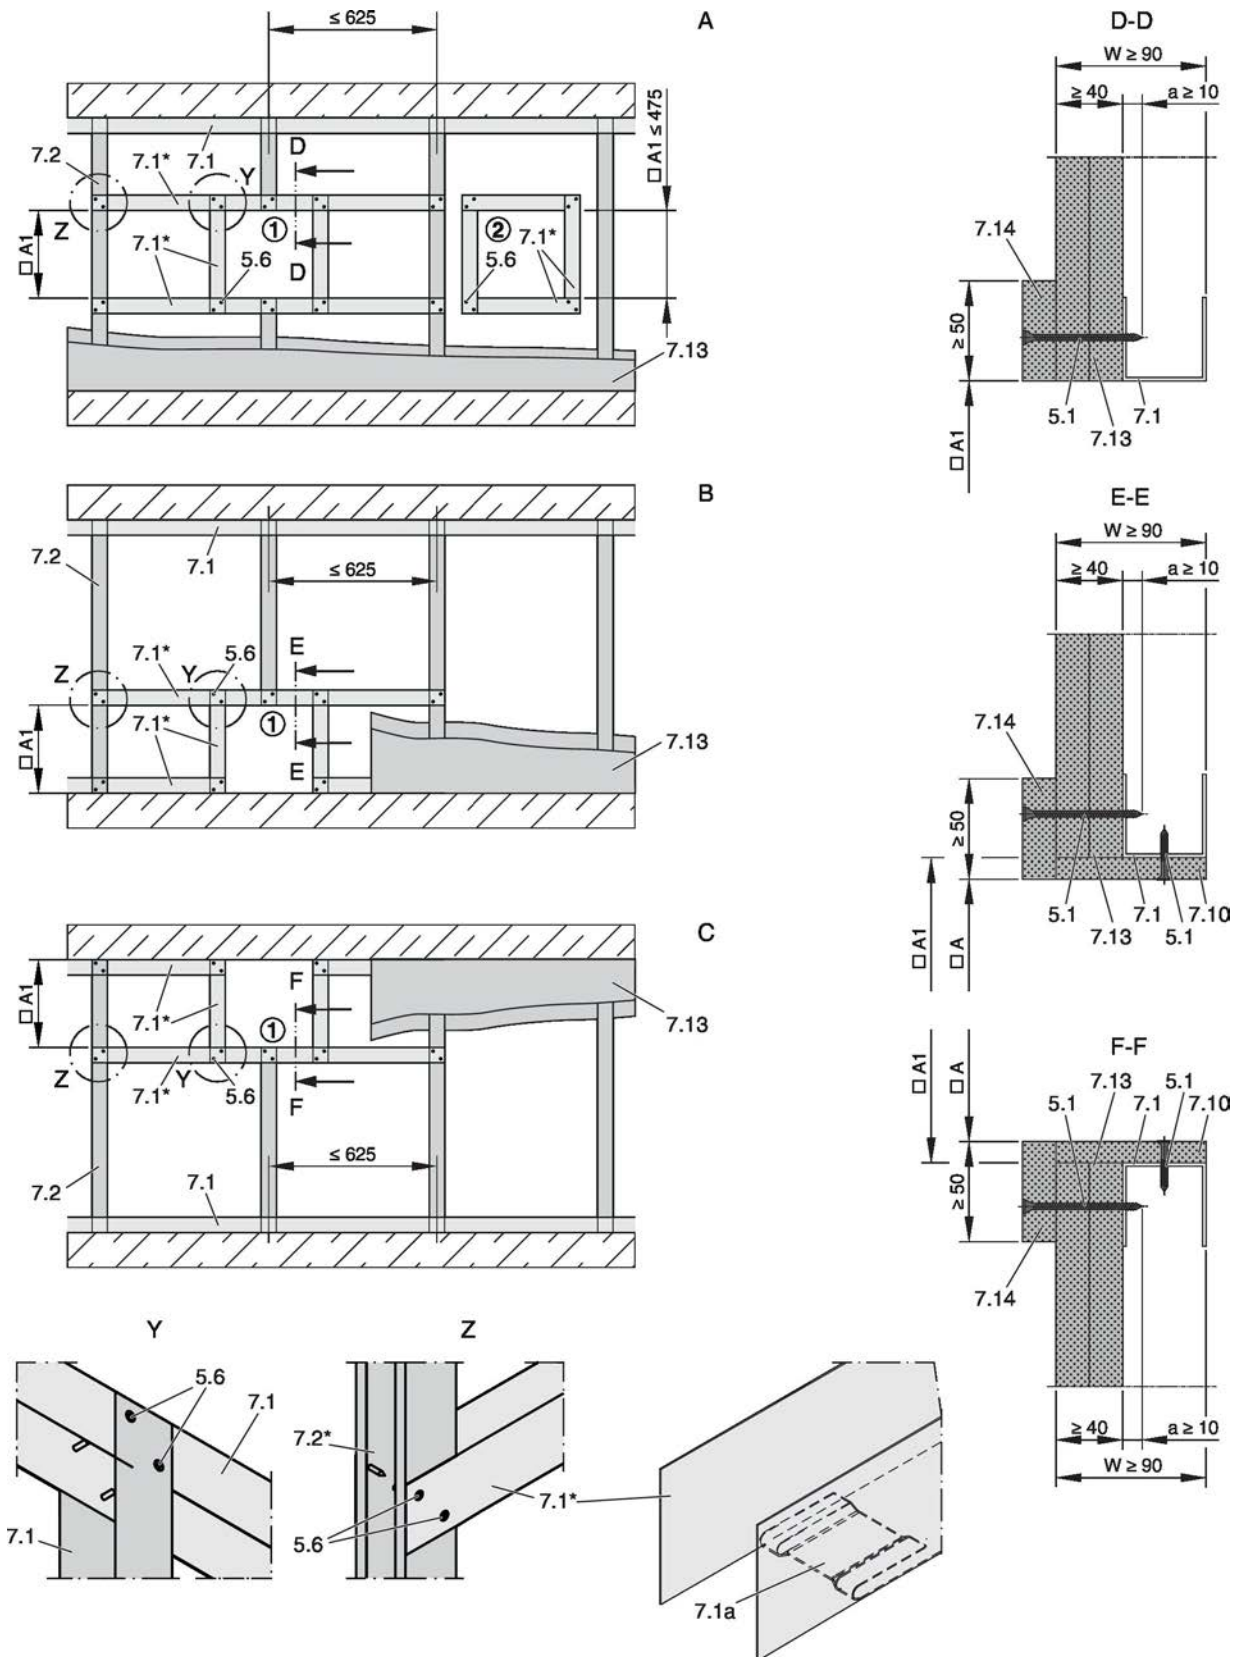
Стены вентиляционных шахт с металлическим каркасом и облицовкой с одной стороны
